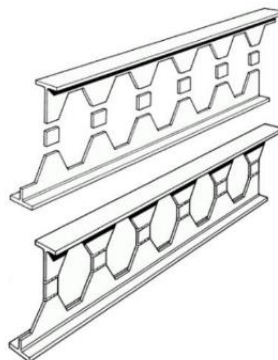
Uso de chapas expansoras em vigas casteladas (GRÜNBAUER, 2021)
